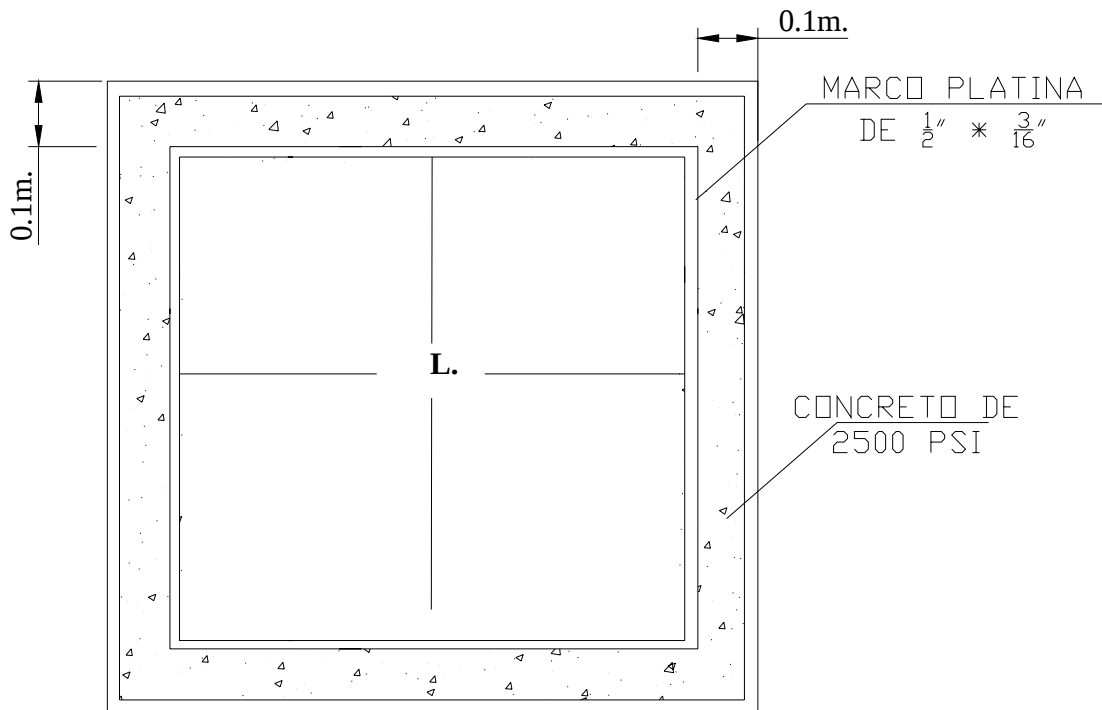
Caja de inspección sencilla en B.T. Vista de planta caja con marco.
